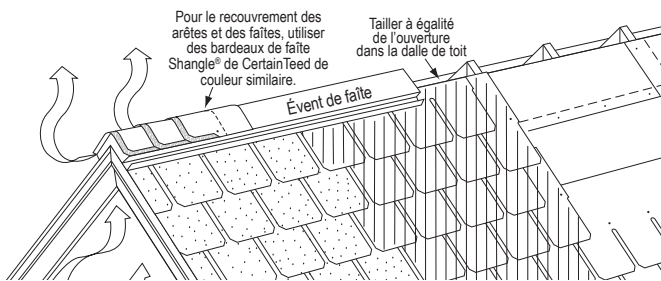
Pose de bardeaux Shingle Ridge sur l'évent de faitage.
